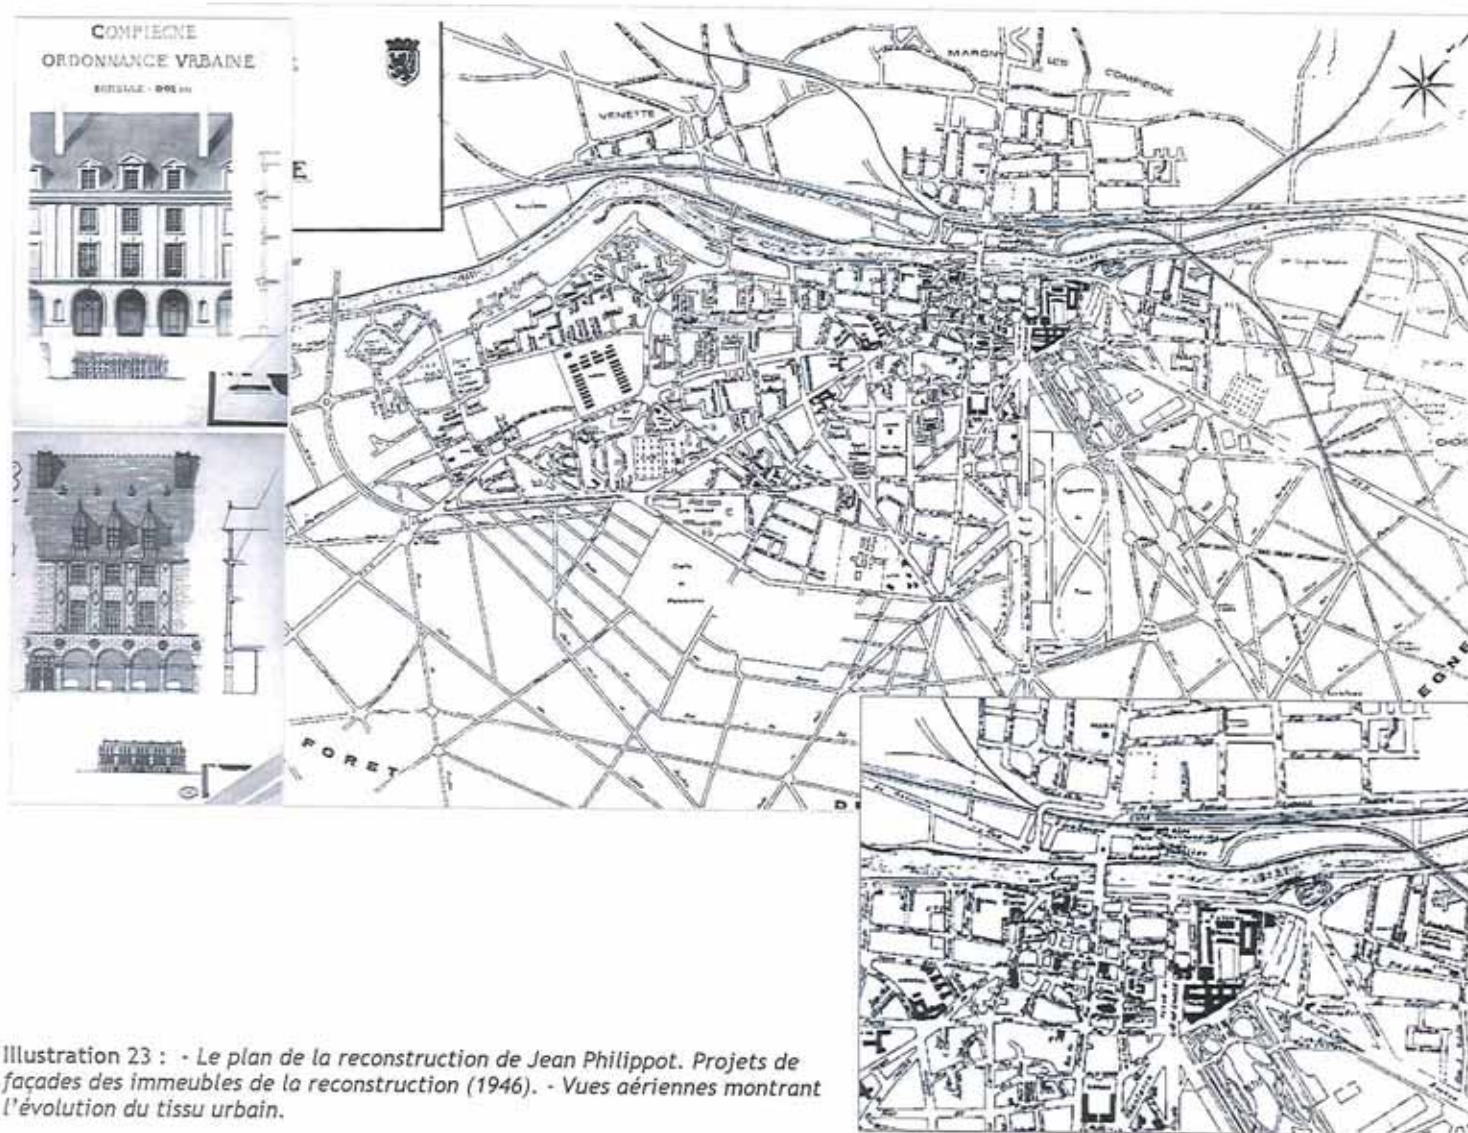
Le plan de la reconstruction de Jean Philpott. Projets de façades des immeubles de la reconstruction (1946). - Vues aériennes montrant l'évolution du tissu urbain.
